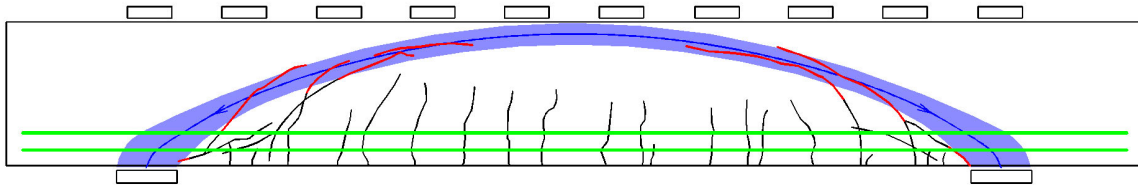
Balken BO 4 mit überlagerter Druckparabel und zugehörigen Rissen
